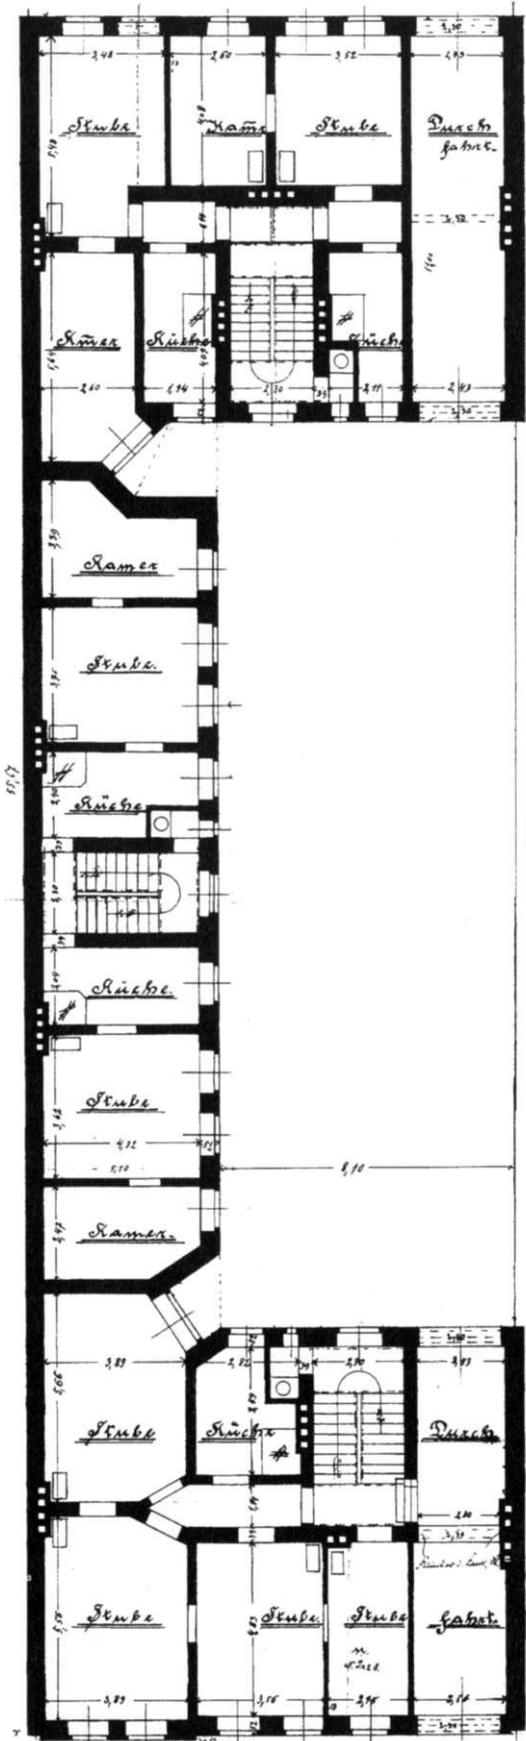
Grundrißtyp A, Erdgeschoß Immermannstraße 29
